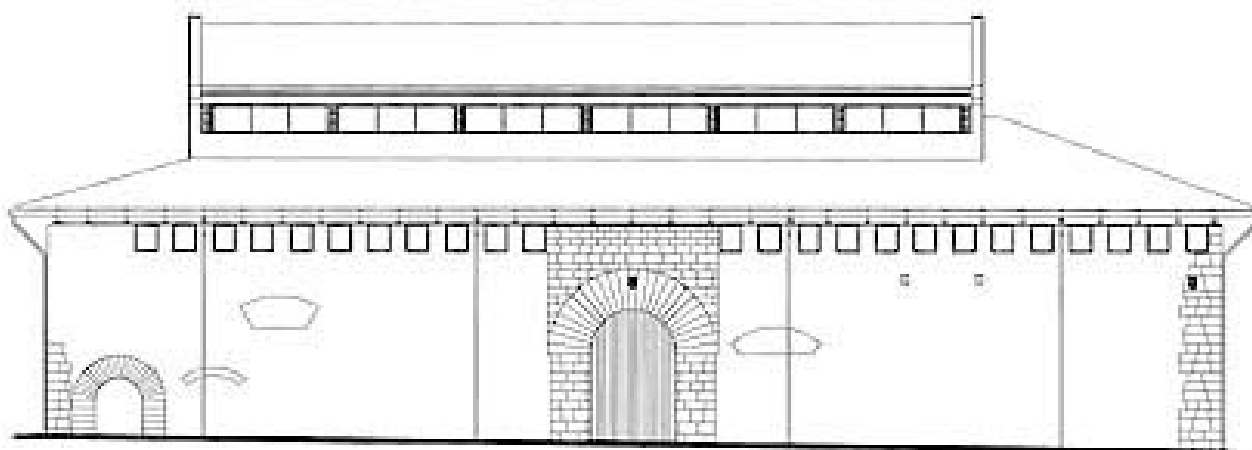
Alzado Calle Almudín. Fuente Web: ViA arquitectura
